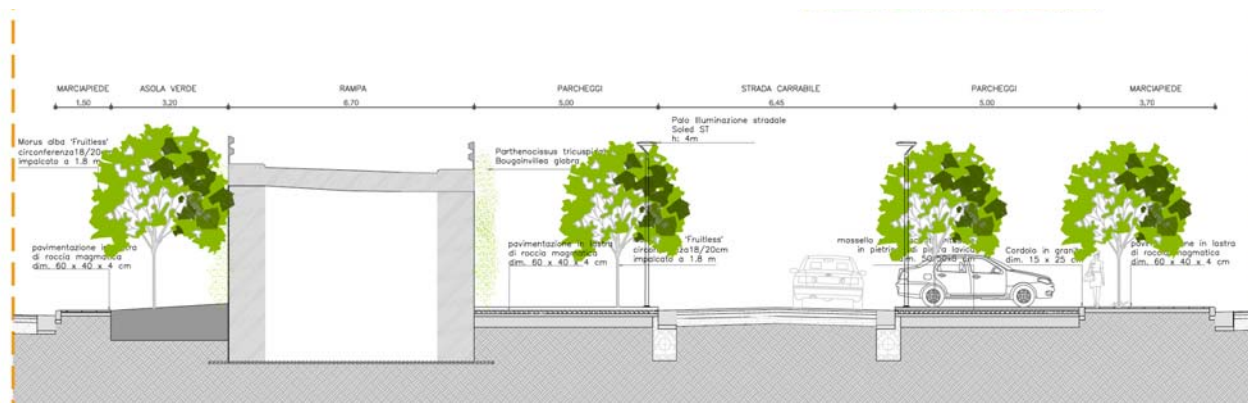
Sezione tipo rampa di uscita SS 162 con area di sosta area ovest
